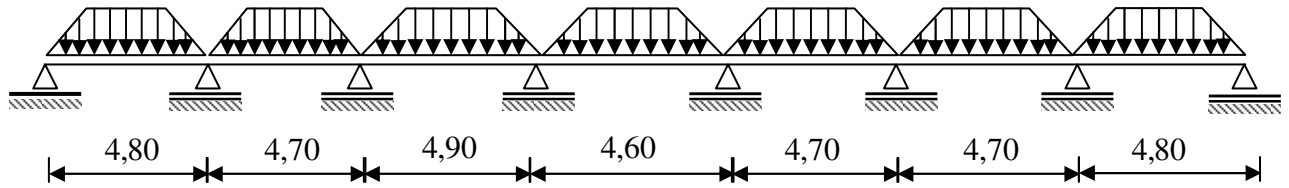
Distribution des charges sur les poutres aux sens principales
